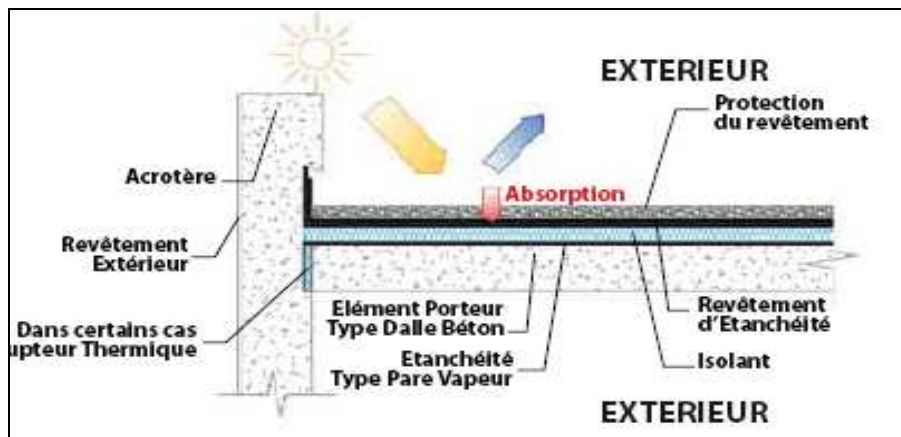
croquis d'isolation de la dalle par l'extérieur
